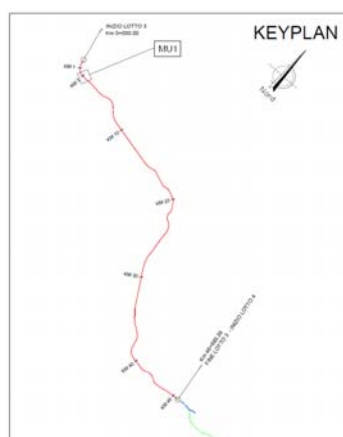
Posizione planimetrica dell'opera MU01.
